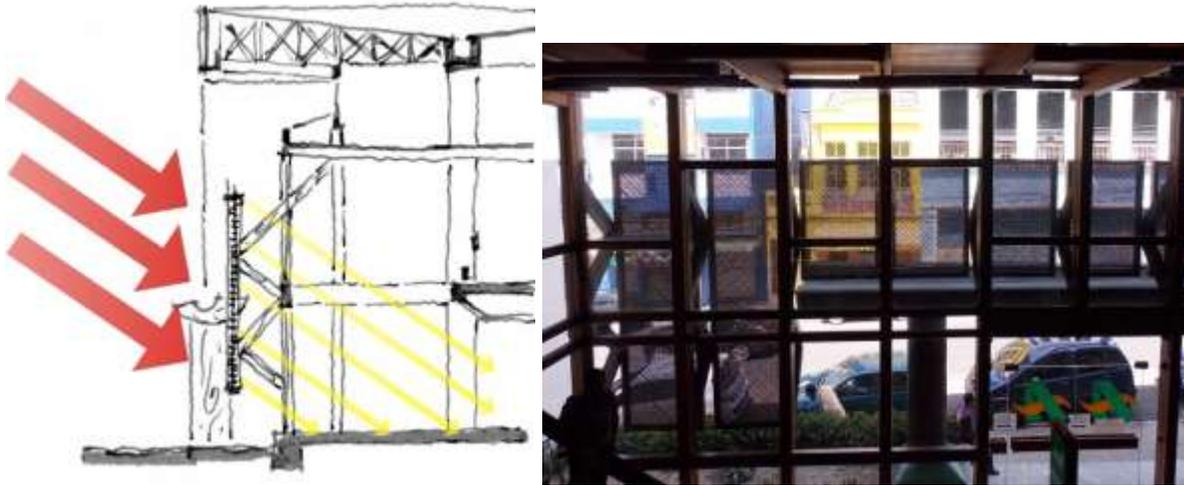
Perfil esquemático dos painéis de muxarabi do BASA (1973). Croqui: CANTALICE II.
